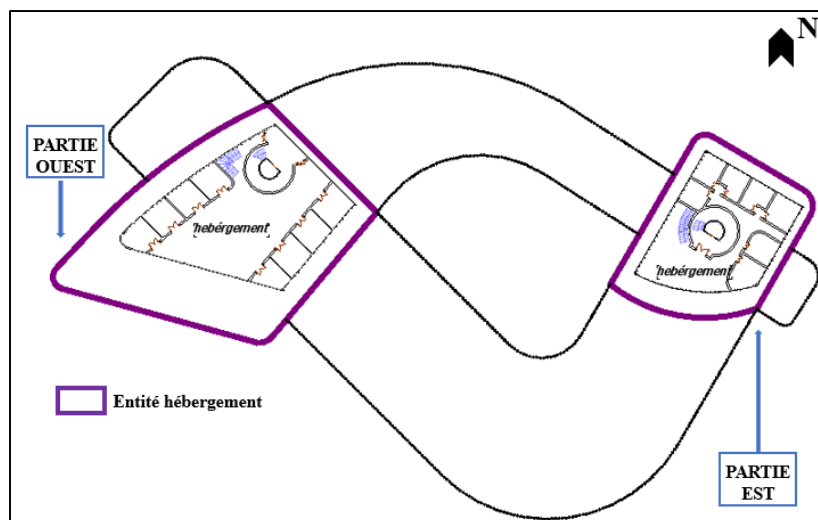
Plan 4^{ème} Etage +24.00 Source : Auteur
